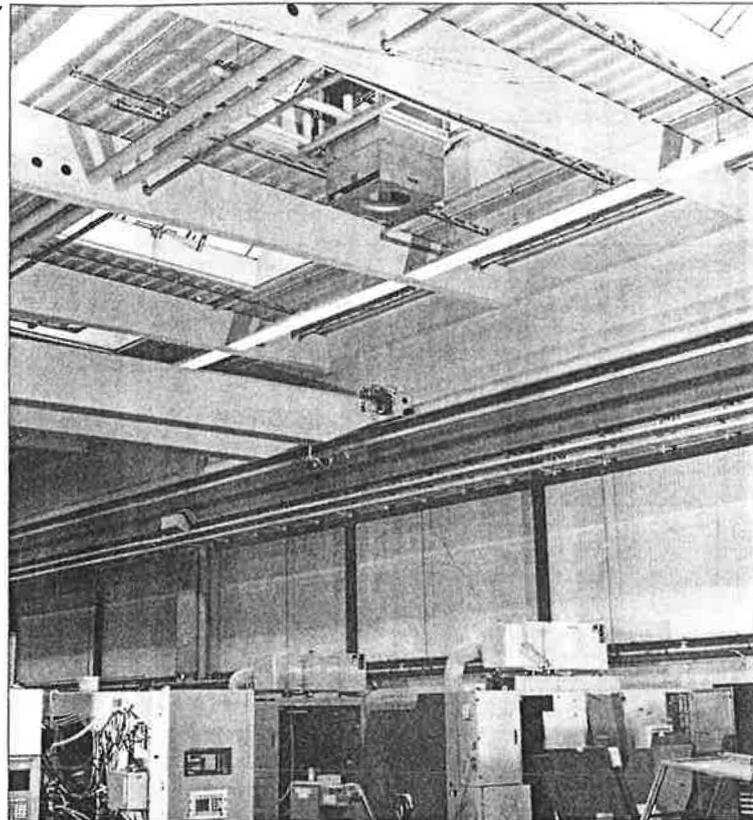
| Produktionshalle mit Deckenkran; dezentrale Lüftungsgeräte im Hallendach eingebaut.
